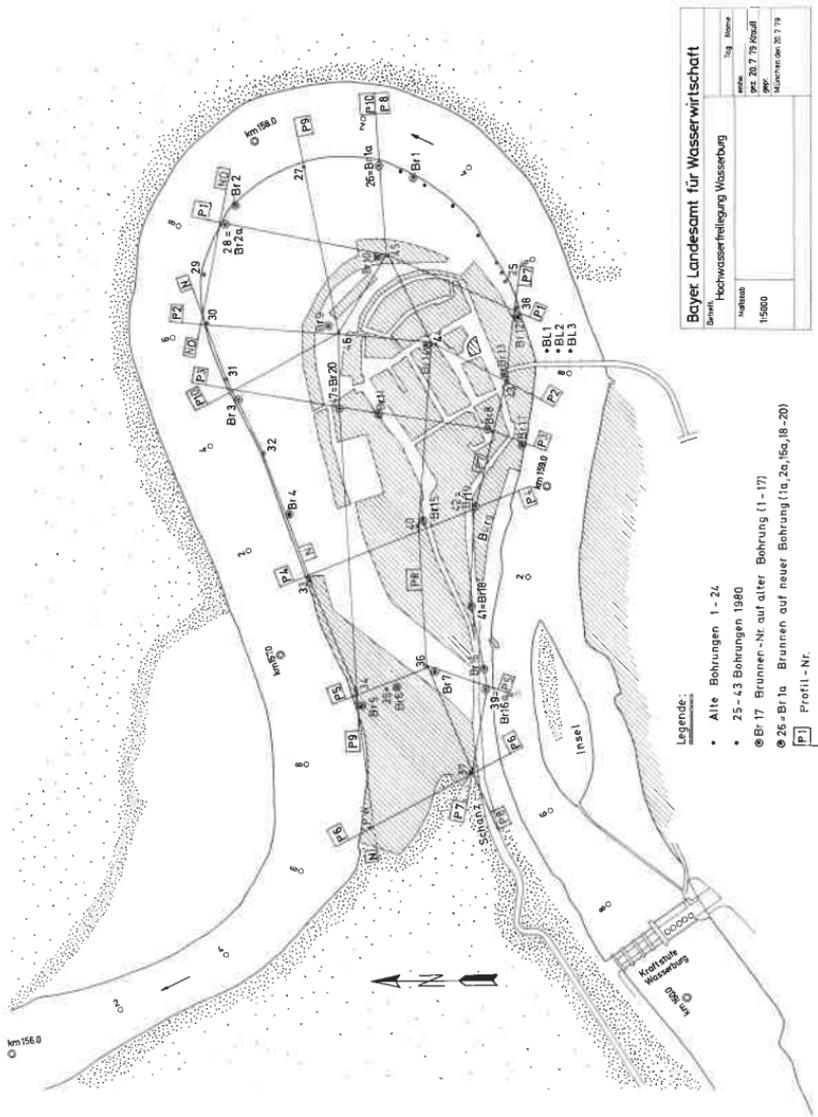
Übersichtslageplan mit Bohrungen, GwBeobachtungsbrunnen und Lage der Profile.
